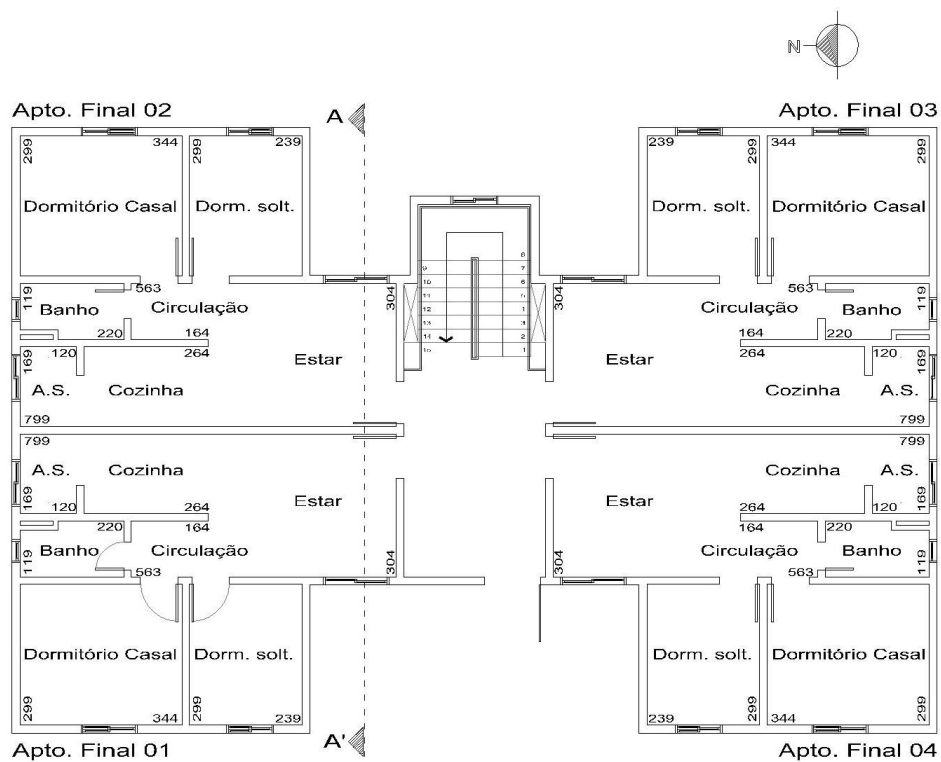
Planta baixa do pavimento térreo (FAGUNDES, 2014).
